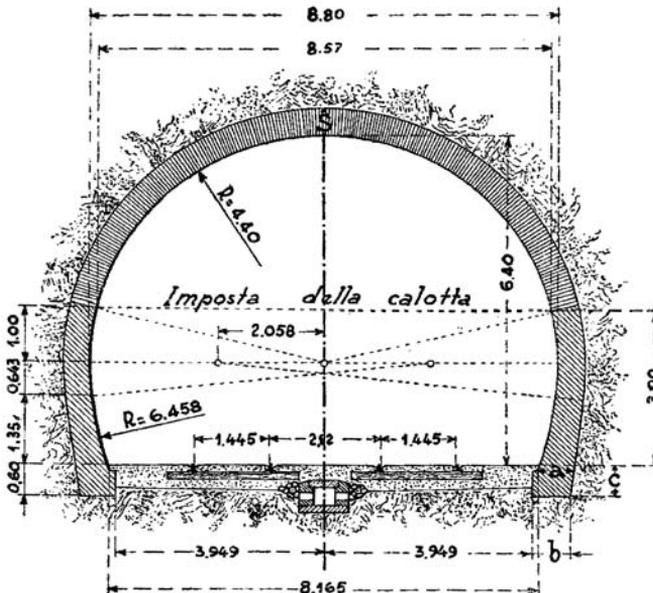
Sezione trasversale galleria ferroviaria.
